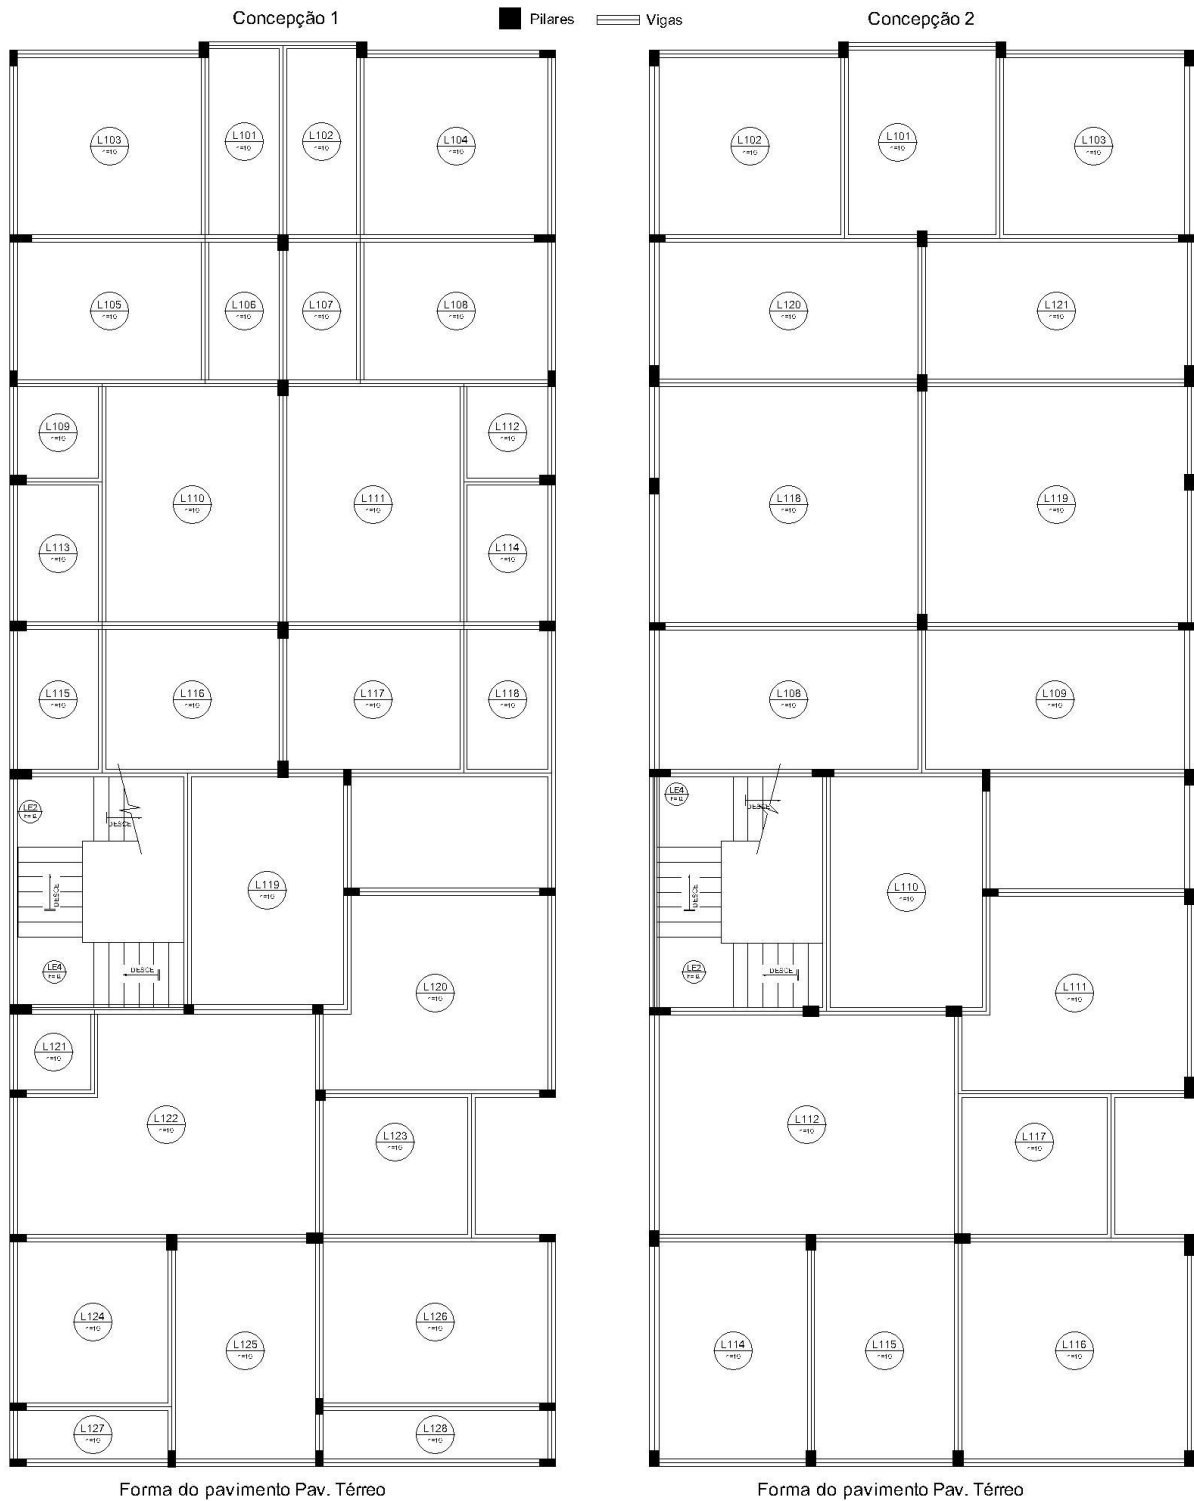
Planta de forma do Pavimento Térreo: a) Concepção 1; b) Concepção 2
